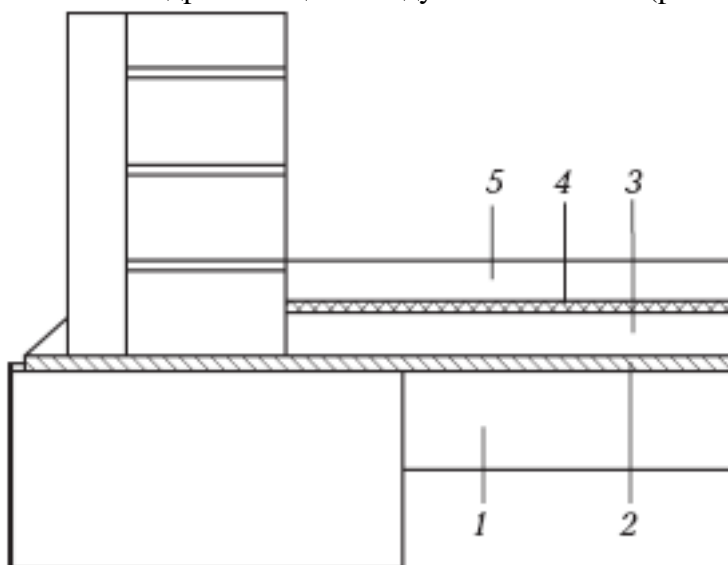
Утепление пола подвала: 1 – фундаментная плита или грунт с выравнивающим слоем песка; 2 – противокapиллярная изоляция; 3 – теплоизоляция; 4 – гидроизоляция поверх слоя минваты (для пенополистирола такой слой не нужен); 5 – бетонная стяжка
